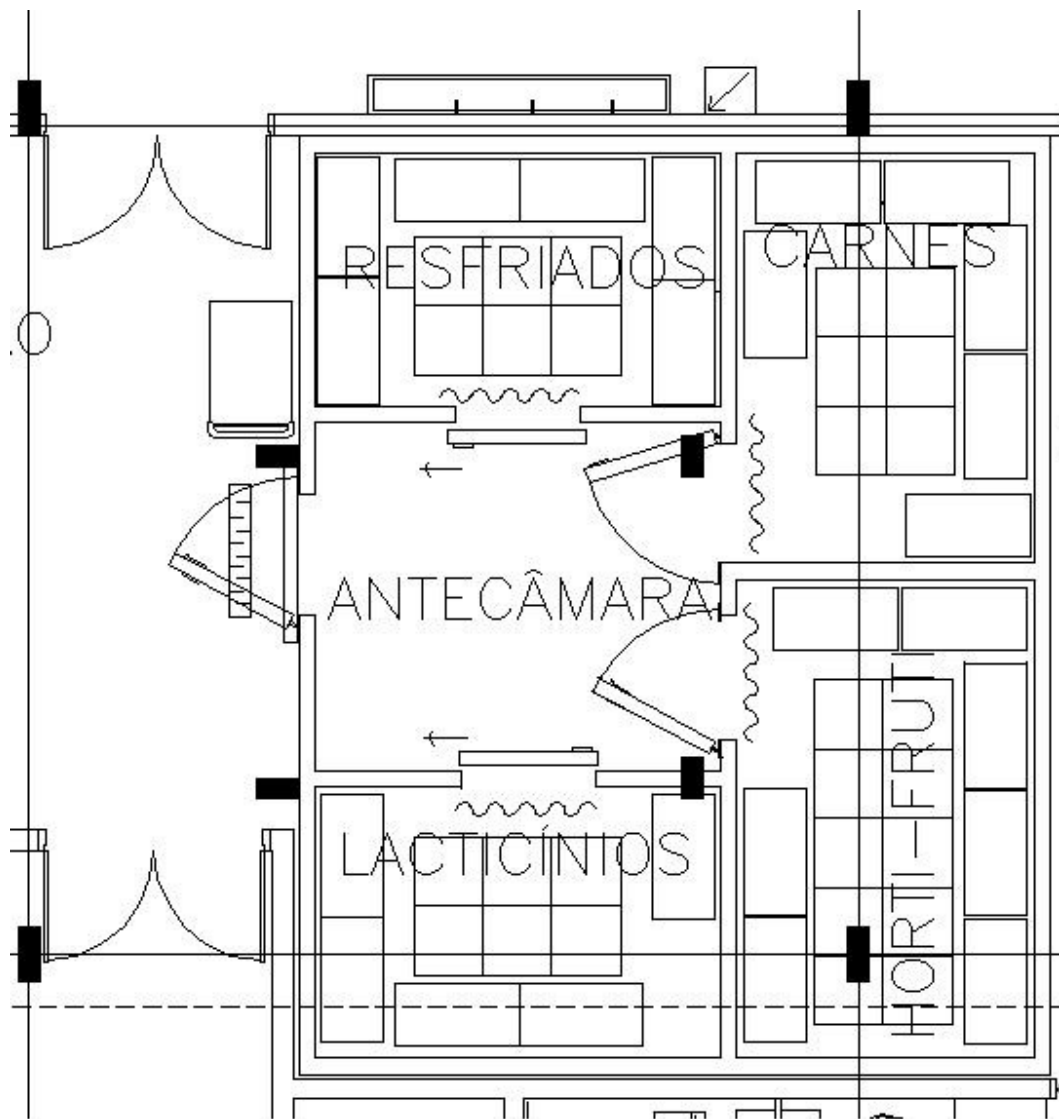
Planta baixa da câmara frigorífica, modulação entre pilares - 7,50 m
